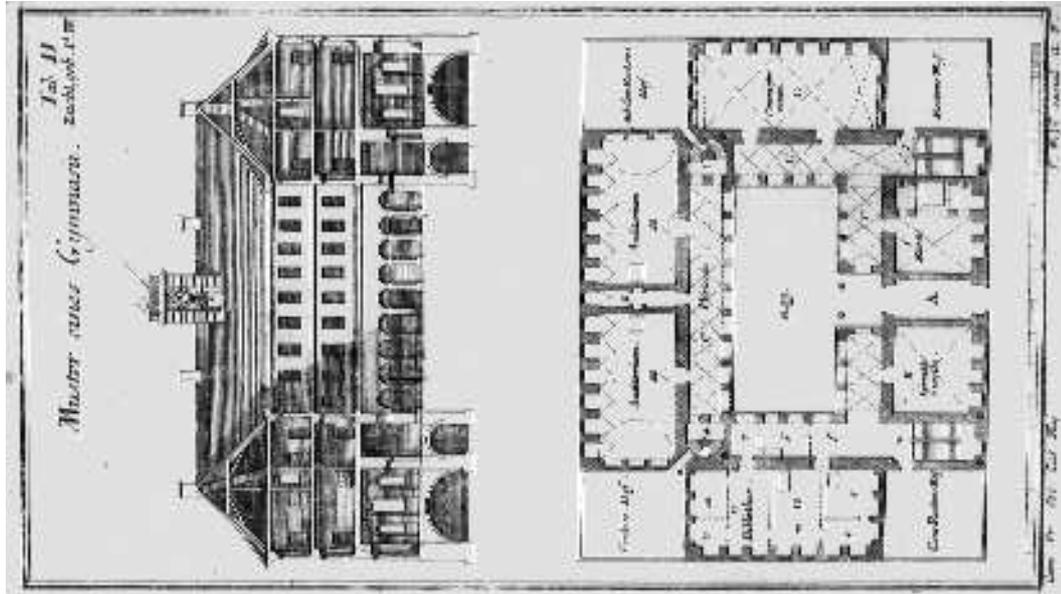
Sturm, Gymnasium, Längsschnitt und Grundriß, 1720
